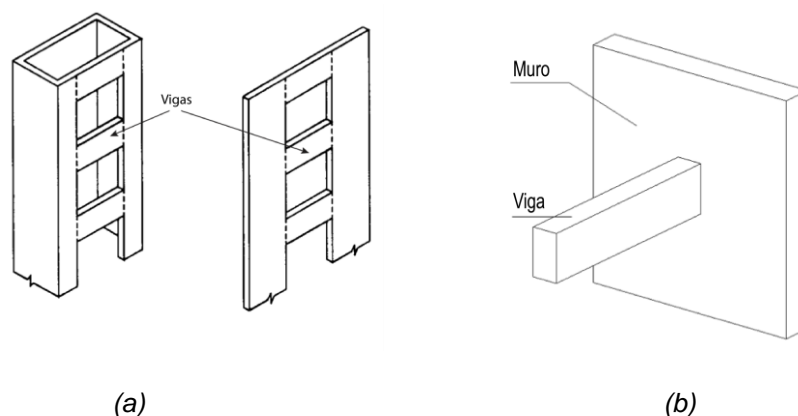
(a) Conexión dentro del plano o viga de acople. (b) Conexión fuera del plano.
